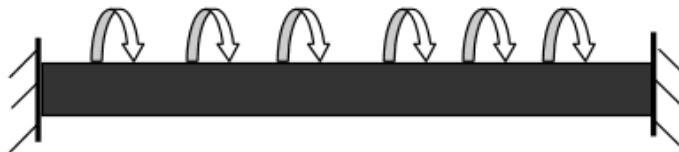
Schéma statique de la poutre palier à la torsion
